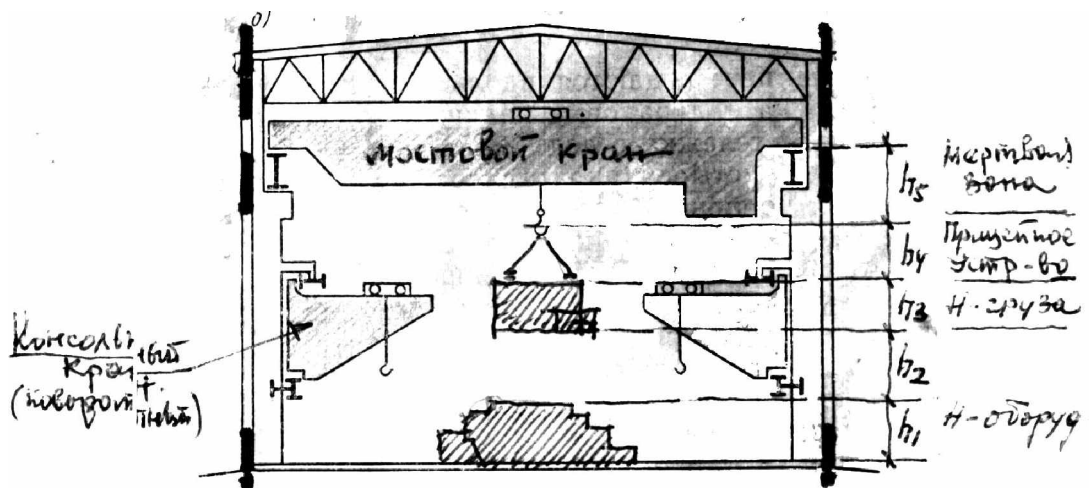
Схемы расположения кранов в поперечных разрезах зданий:
